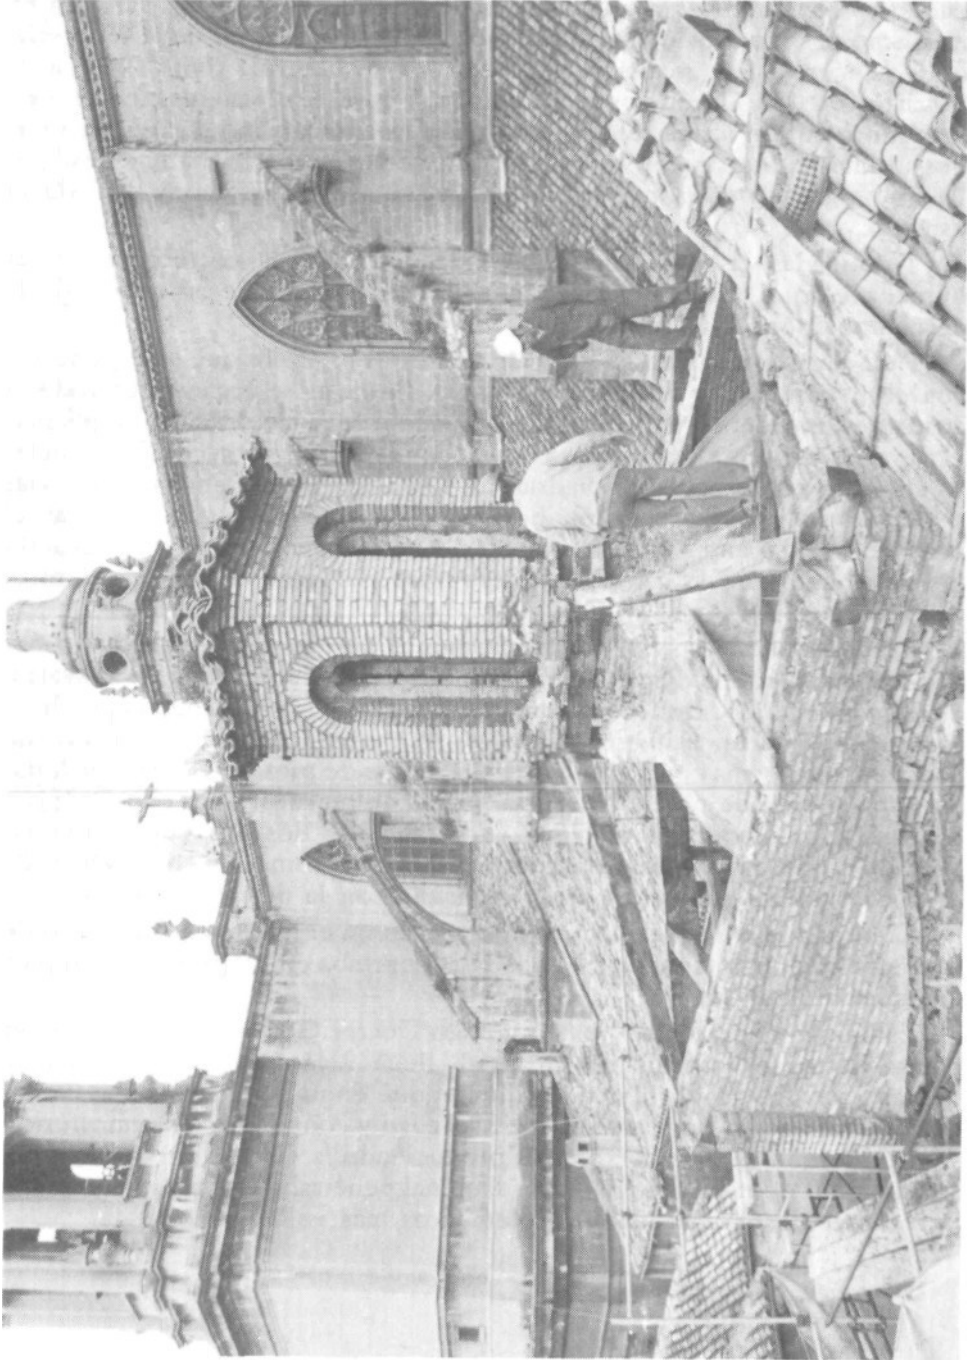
Con la cubierta de la Torre de la escalera de caracol desmontada, se aprecia la primitiva construcción barroca de la misma.
